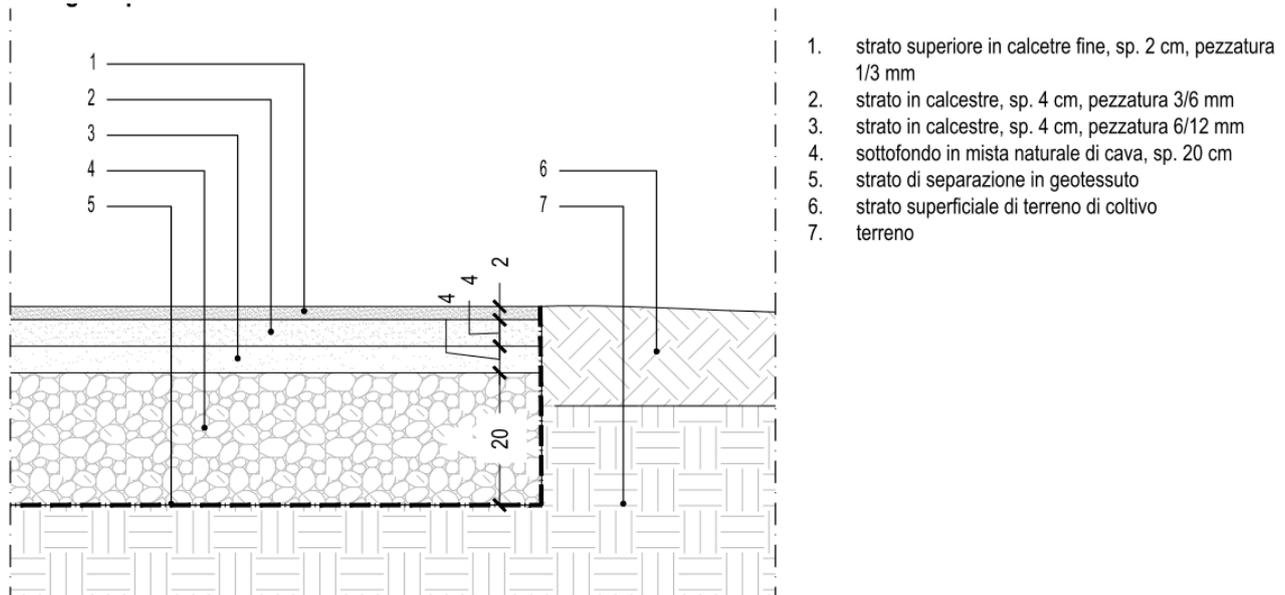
Stratigrafia della pavimentazione in calcestre (estratto tavola dettagli)
